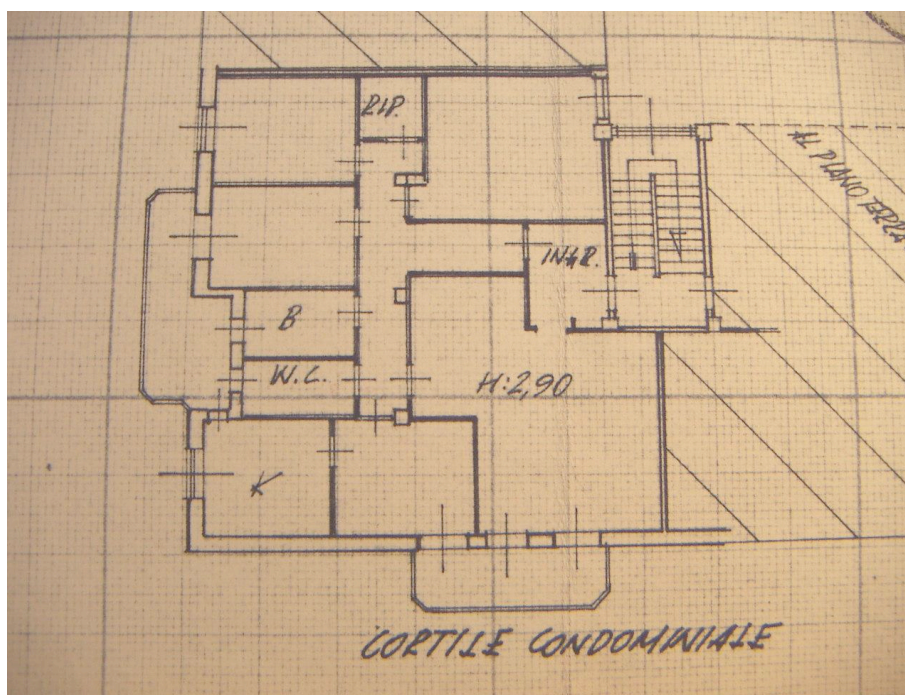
Planimetria dell'appartamento dei signori Renato e Sandra B., Genneruxi¹²⁰. Dall'ingresso si accede al soggiorno-pranzo, mentre accanto alla cucina è posizionato il locale tinello.
